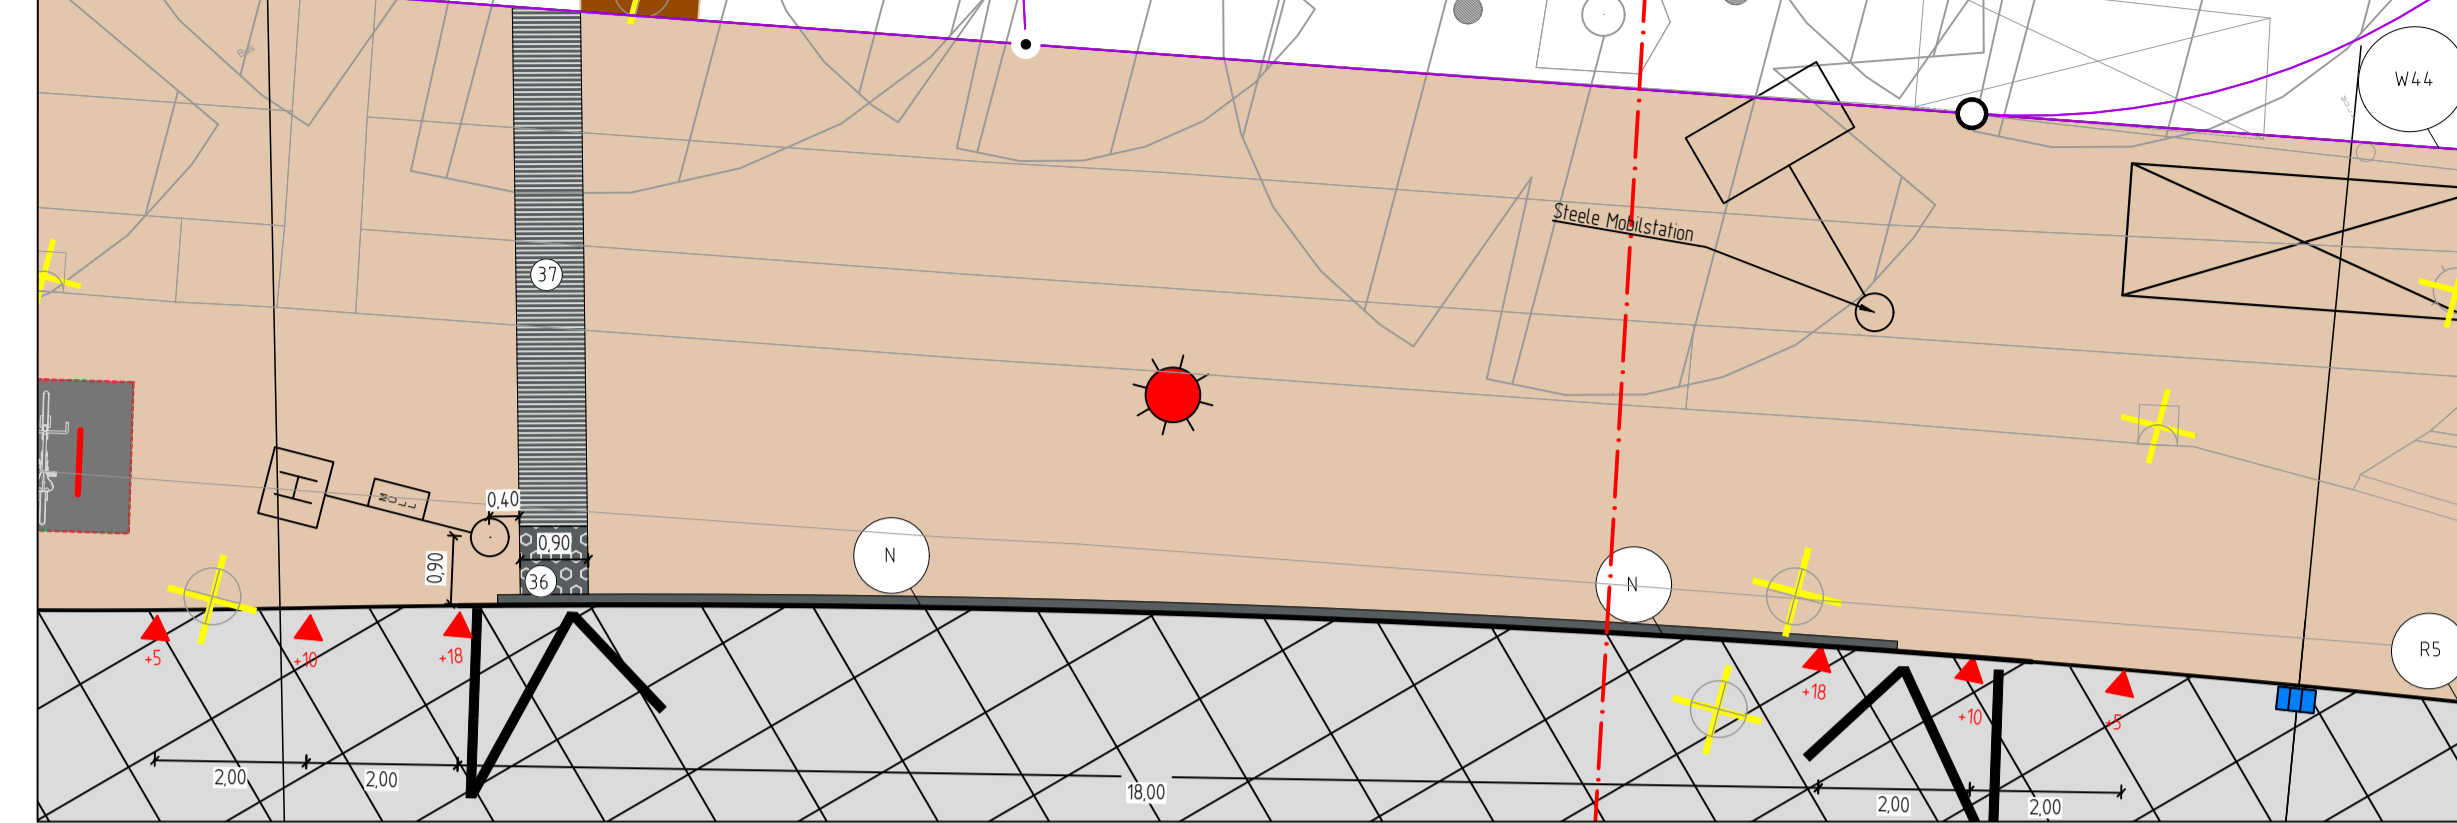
Planung-Taktile Elemente (Straßenquerung)
